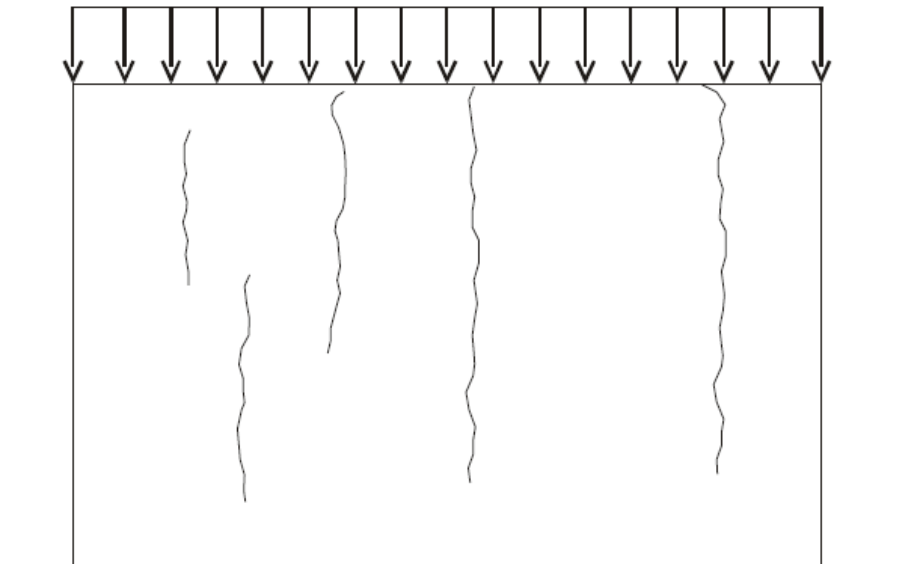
Fissuras causadas por sobrecarga na alvenaria
